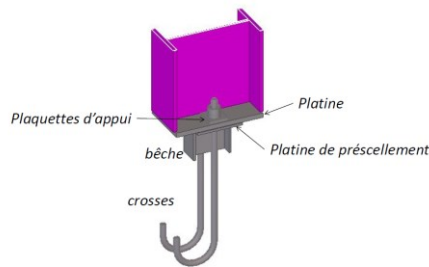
pieds de poteaux articulés avec dispositif de bêche anti-glisserment
